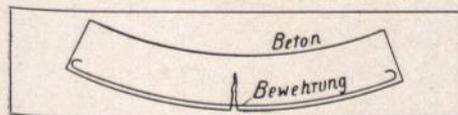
Gerissener Eisenbetonbalken.
